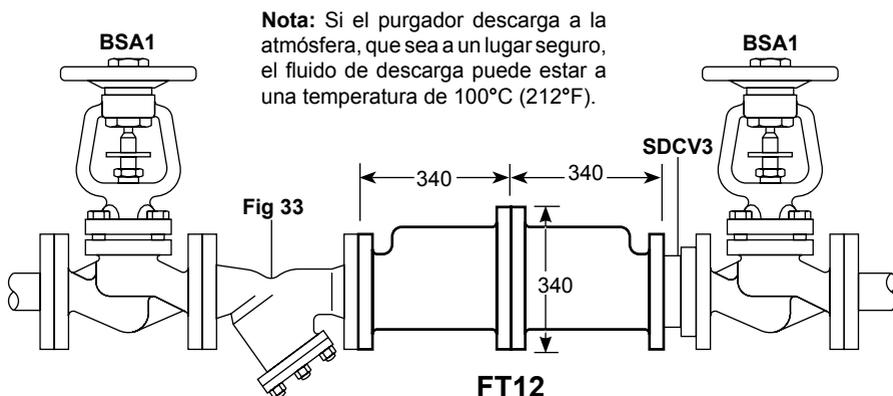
Dimensiones (aproximadas en mm) Peso 82 kg
